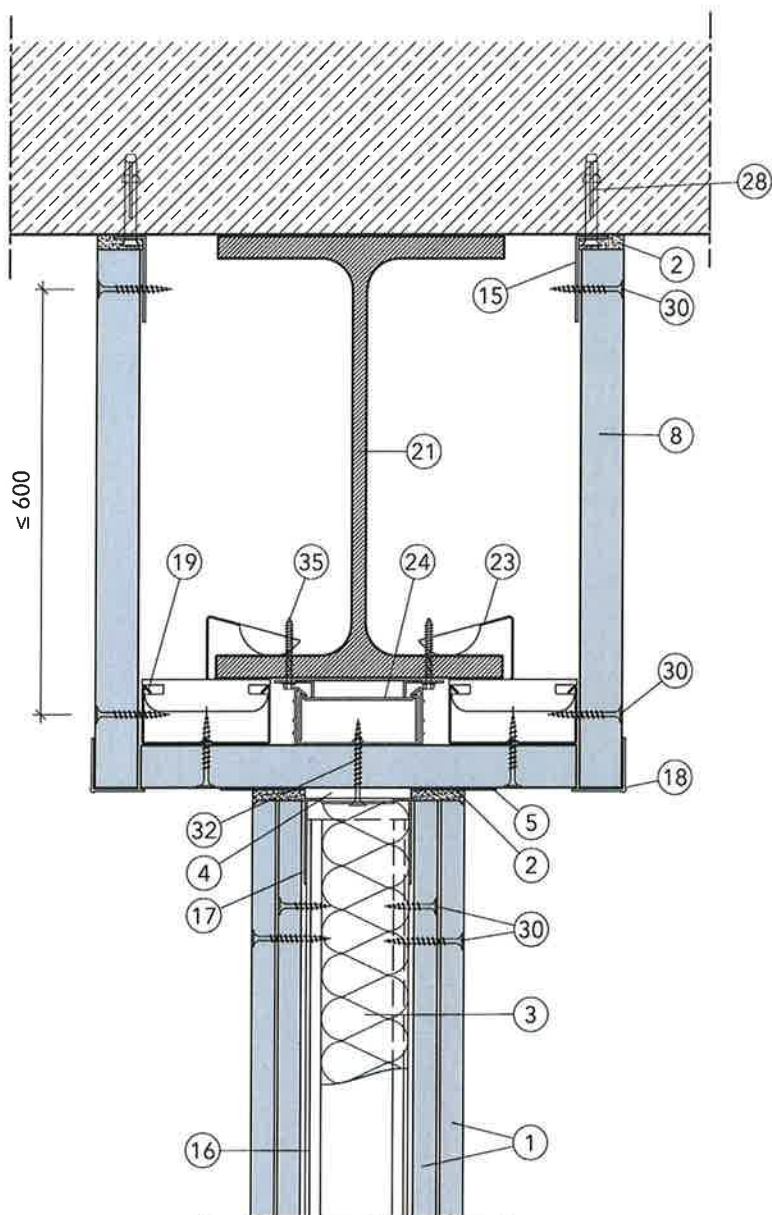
Vertikalschnitt Anschluss an Stahlträger mit Unterkonstruktion
